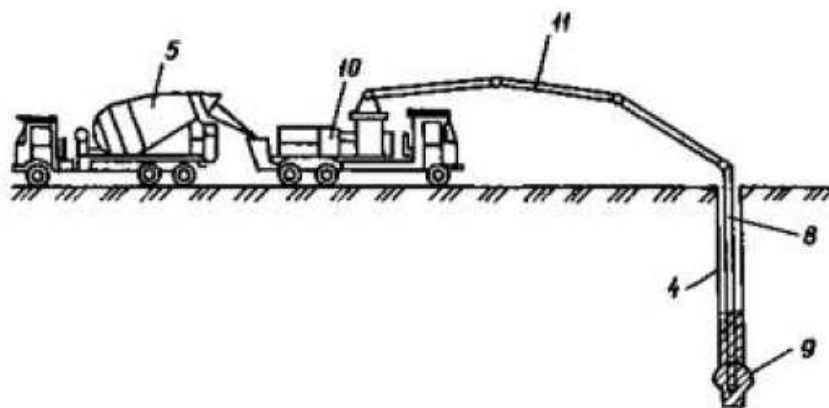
Бетонирование свай напорным методом с помощью автобетононасоса
